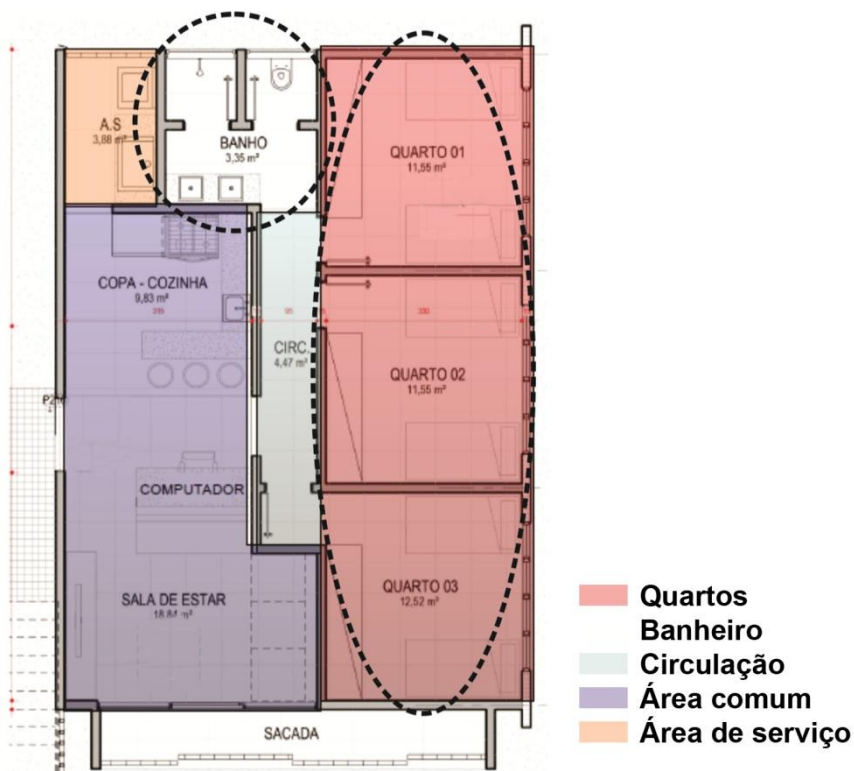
Planta de apartamento tipo da moradia. Fonte (BORGES, 2014, com complementações da autora)
